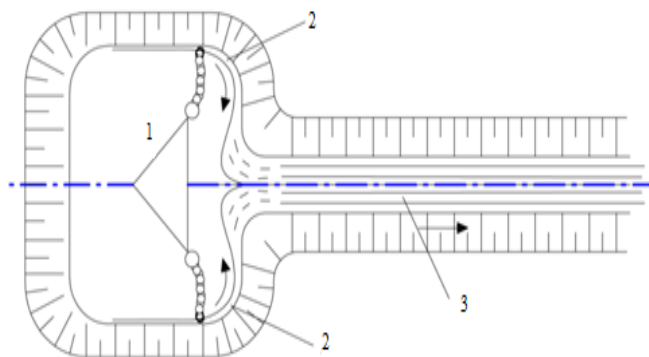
Схемы гидромониторной разработки грунта боковым размывом: 1 – гидромонитор; 2 – боковые забои; 3 – отводная канава
